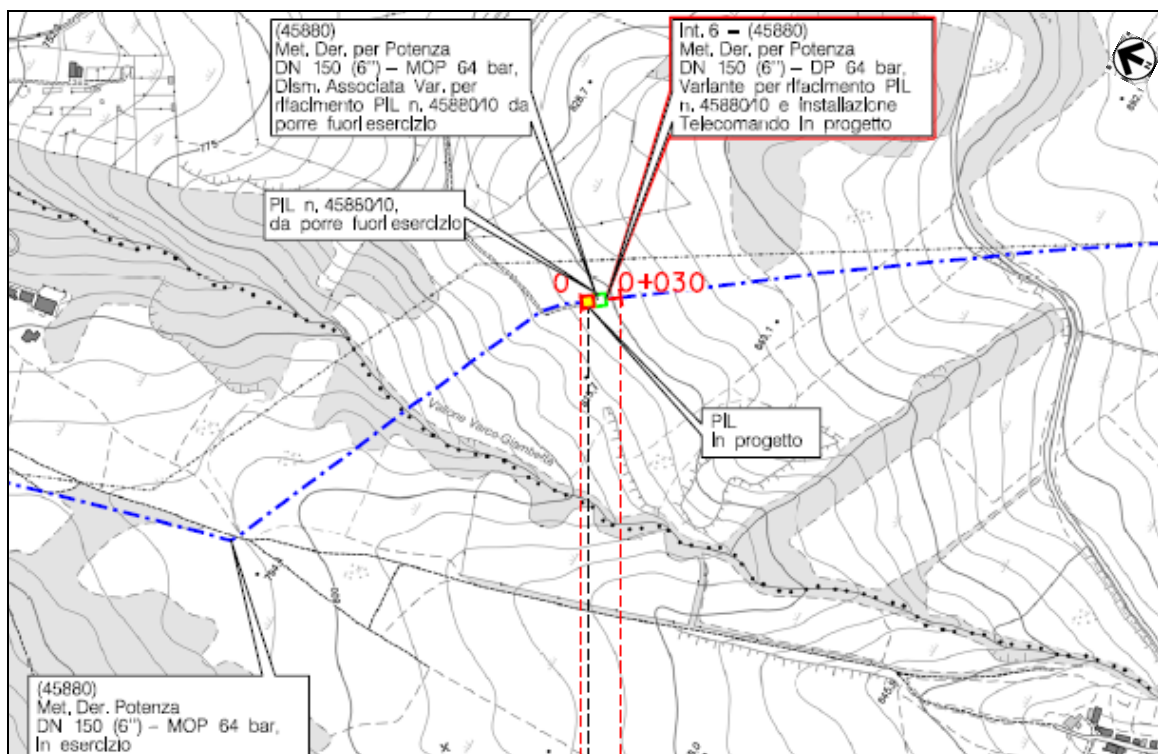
/E.b – Planimetria 1:5.000 con localizzazione dell'area dell'Intervento n.6 (progetto in rosso, dismissione in verde, esistente in blu)
